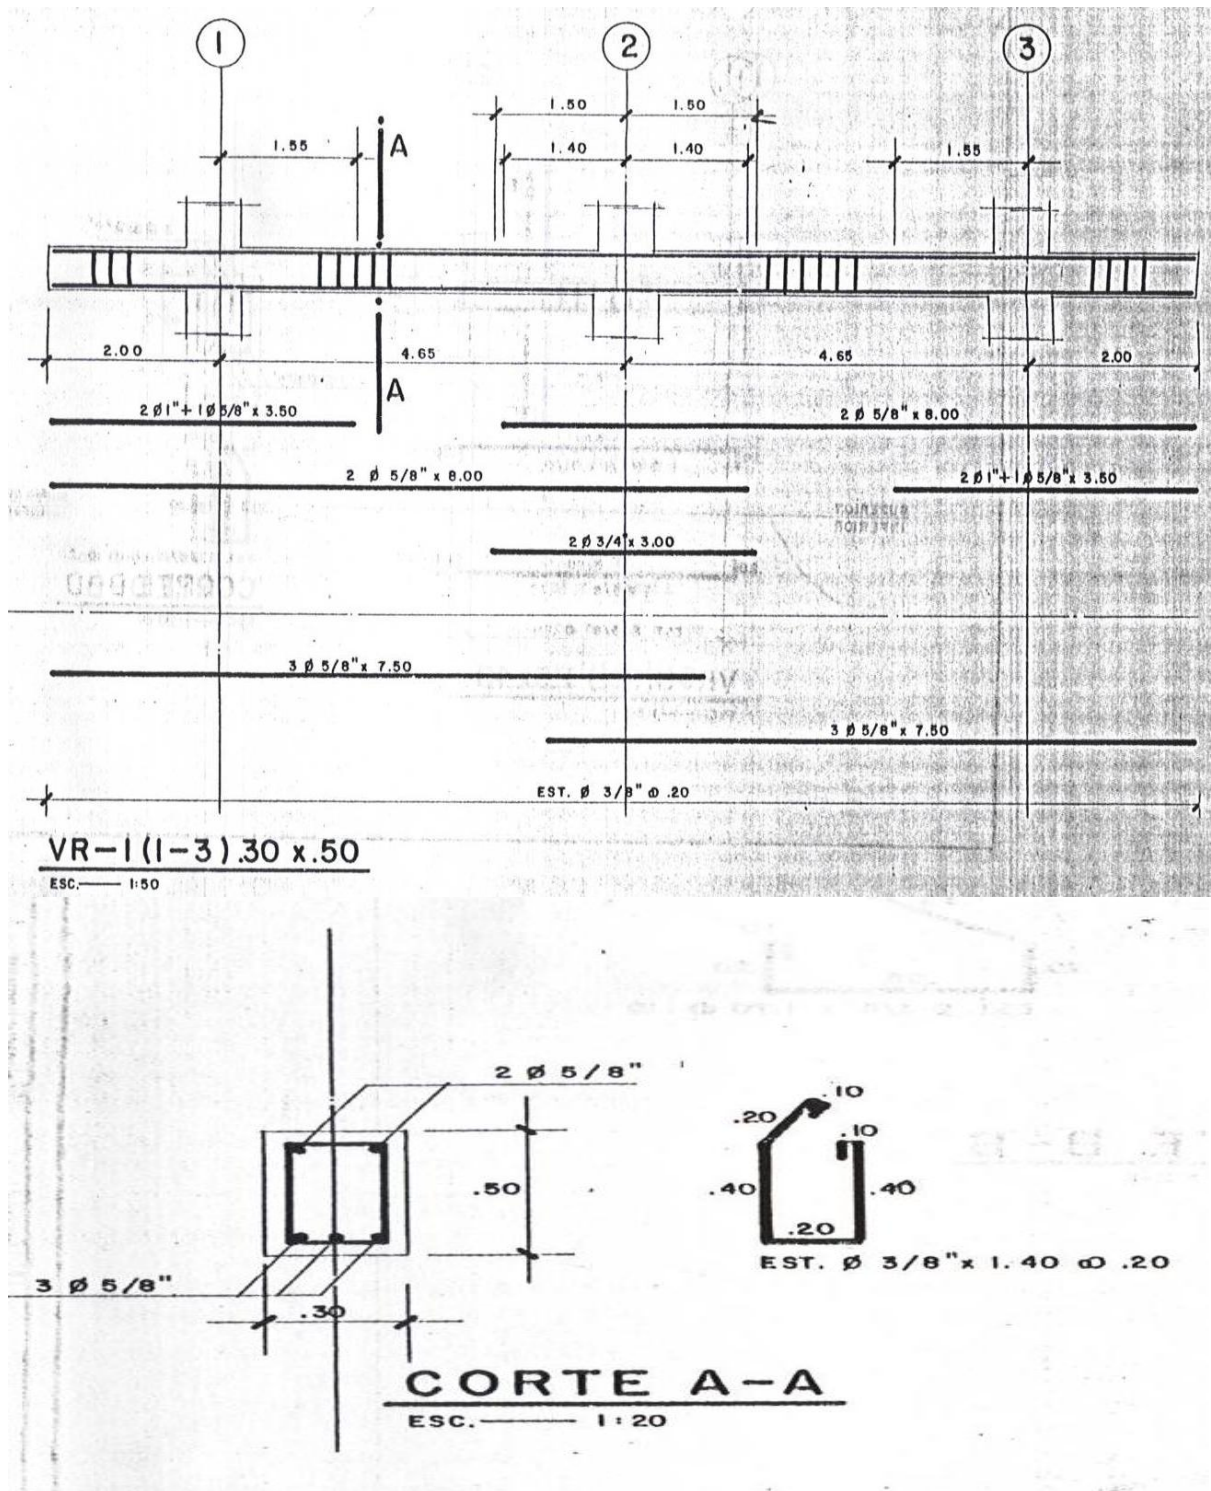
Detalles de viga VR-1. Modulo de Barrio.
